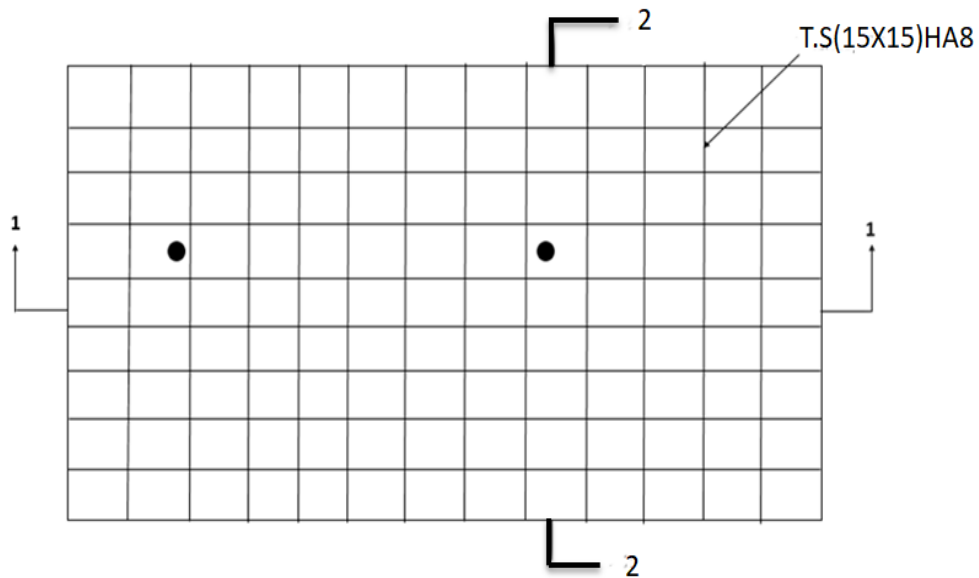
Shéma ferrailage de plancher et disposition les connecteurs
